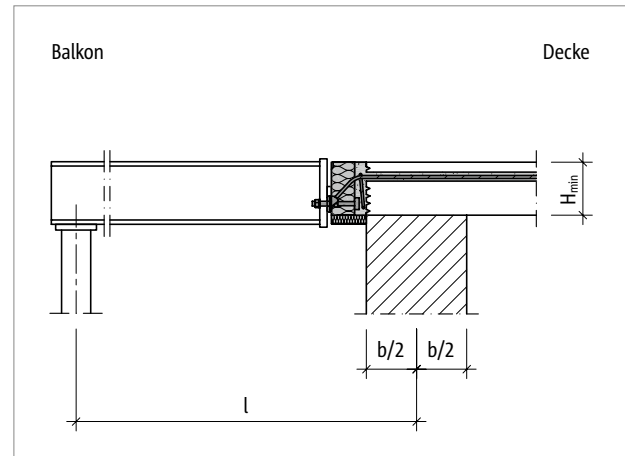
Schöck Isokorb® RT Typ SQ: Statisches System
